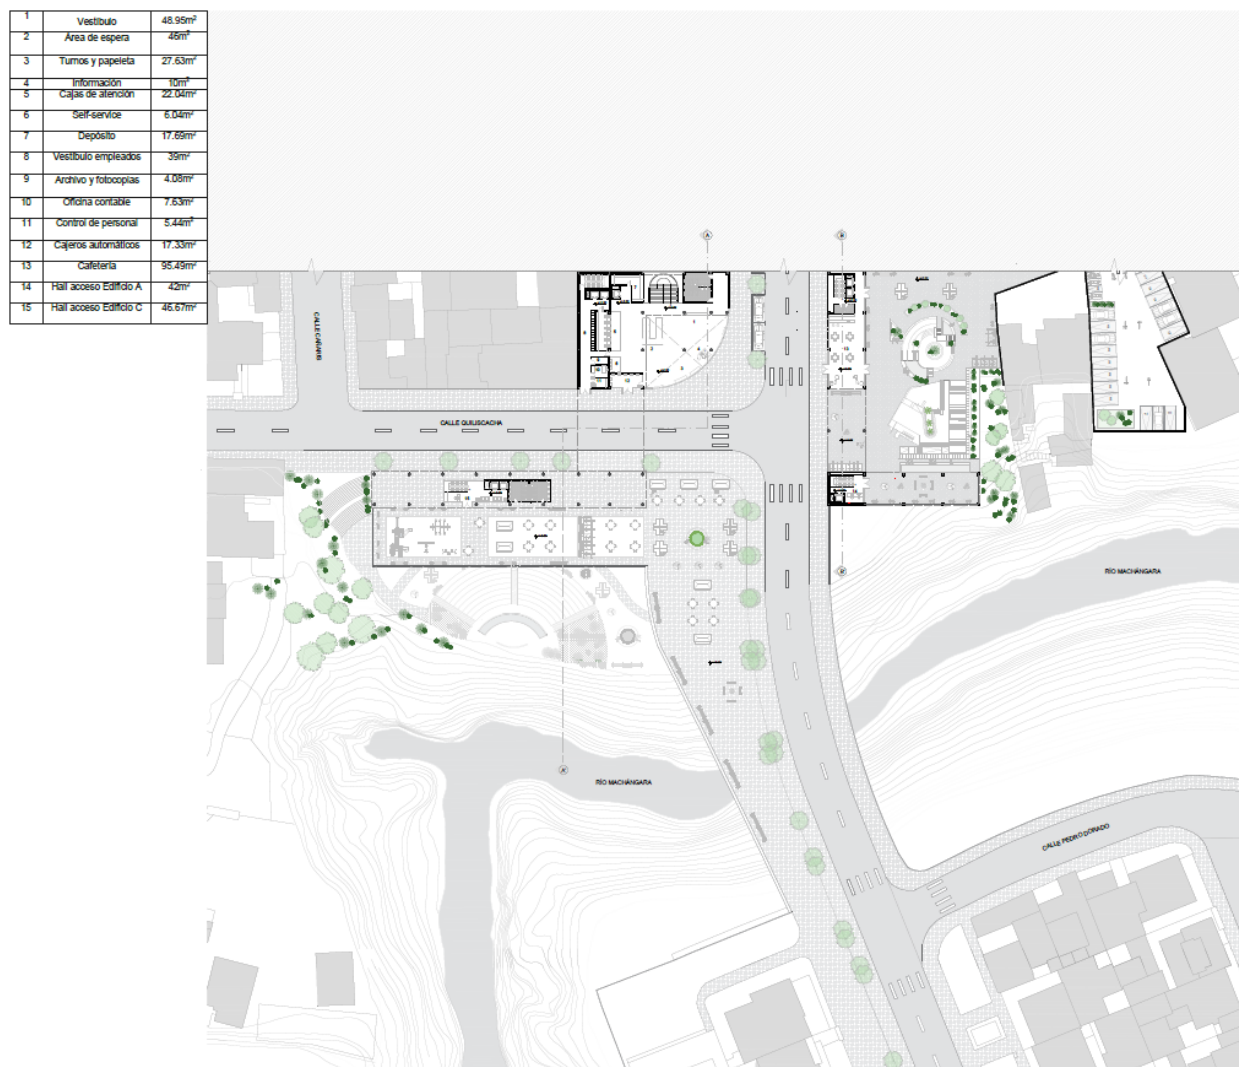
Planta Baja +/-0.00. (elaboración propia)
